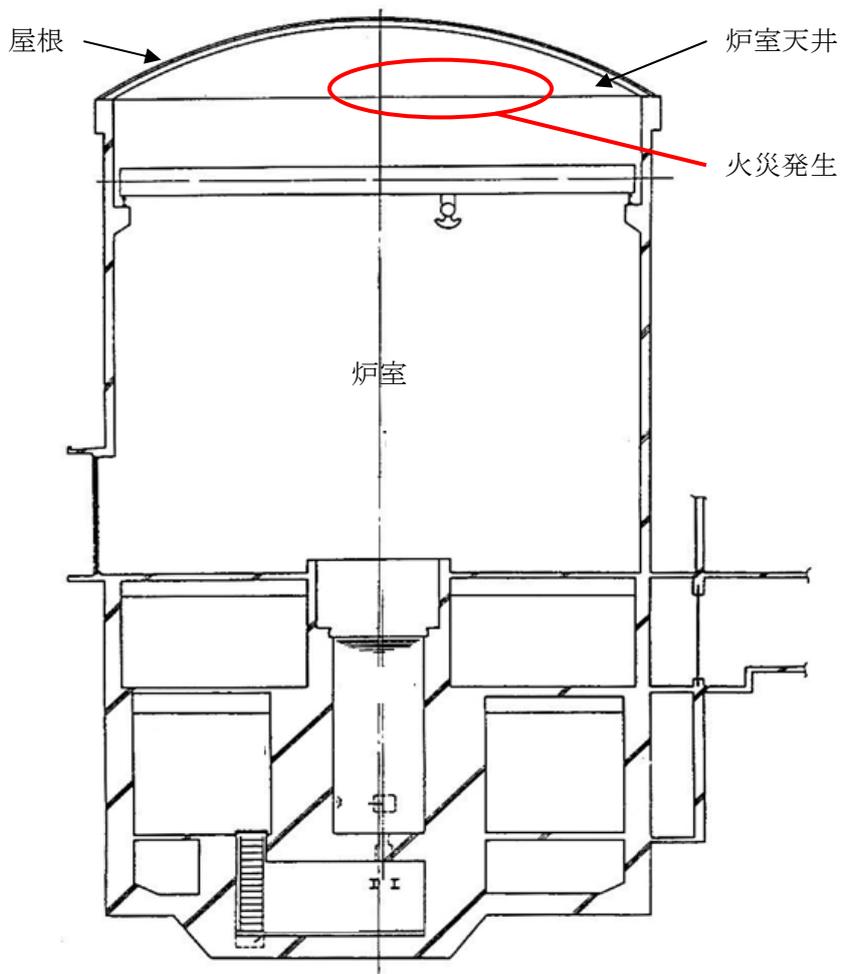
NSRR 原子炉建家 縦断面図
